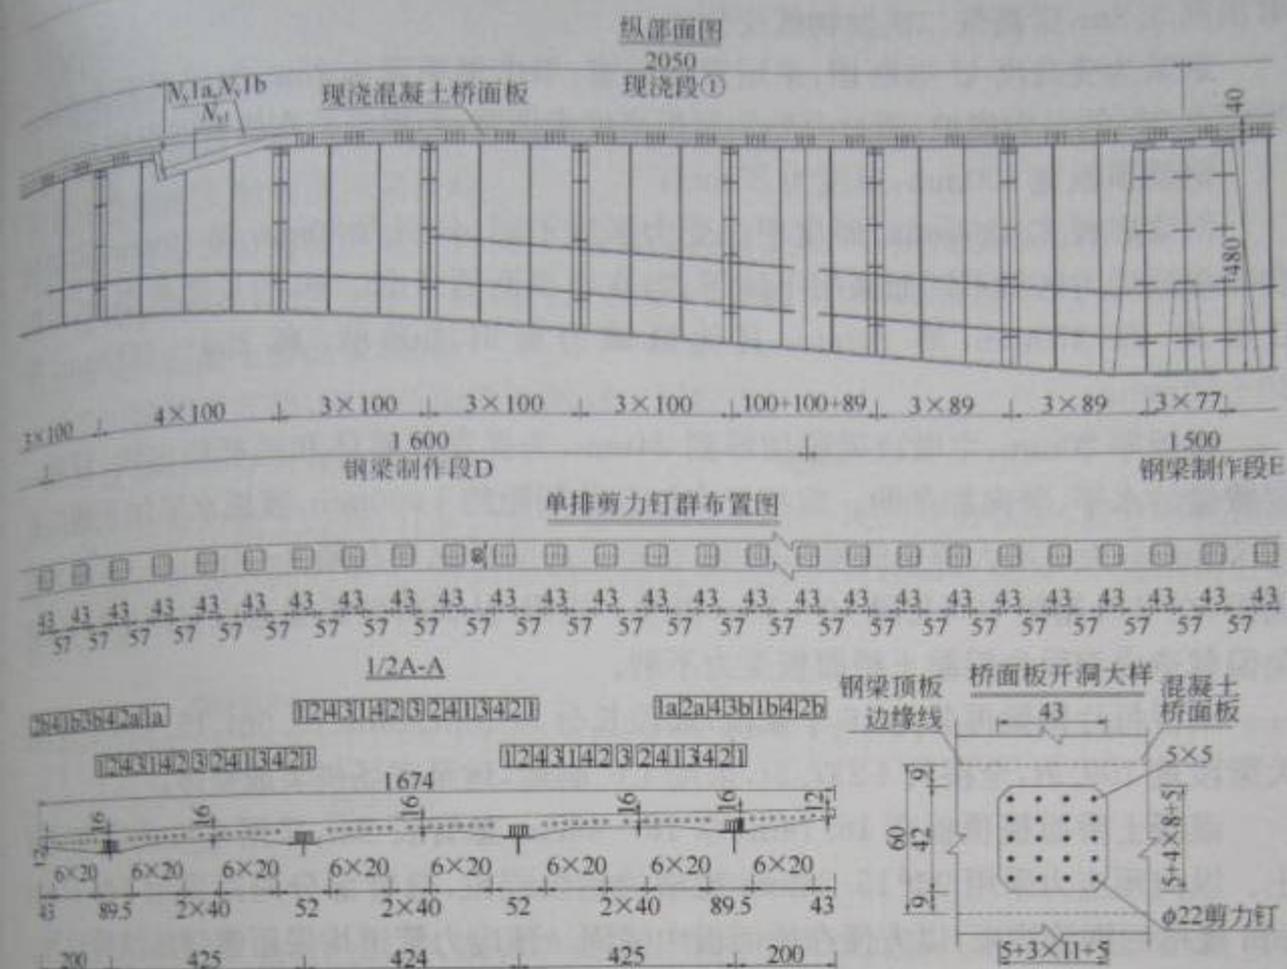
桥面板纵向预应力钢束与剪力钉群布置(尺寸单位:cm)
